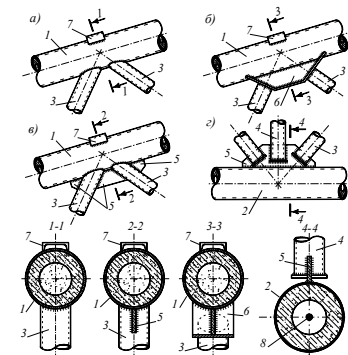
Возможные способы соединения раскосов и стоек с поясами трубобетонной фермы:
